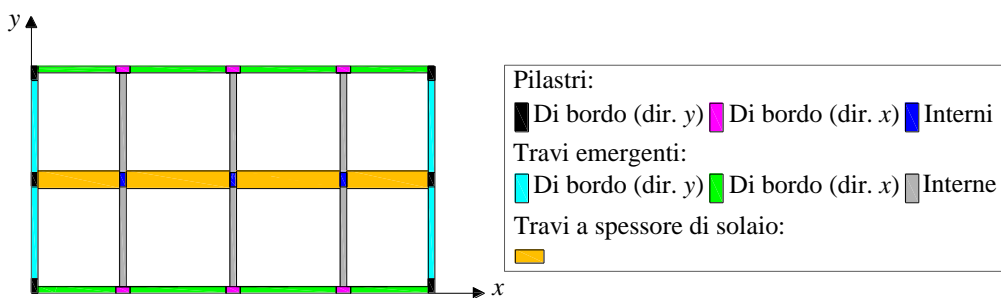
Posizione in pianta degli elementi strutturali in c.a..
